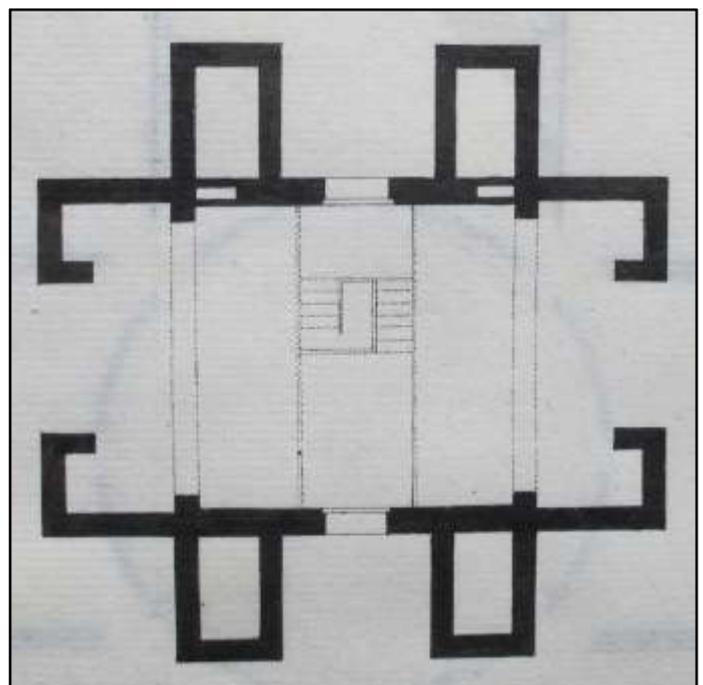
Plan du premier étage des guérites de part et d'autre de la route de la Villette.
